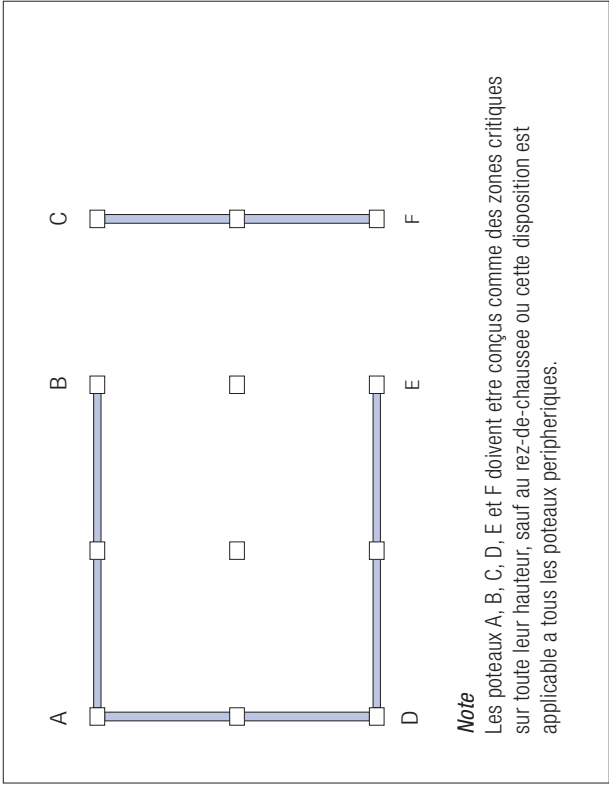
Exemple de poteaux en interaction avec la maçonnerie et nécessitant des dispositions constructives spécifiques
